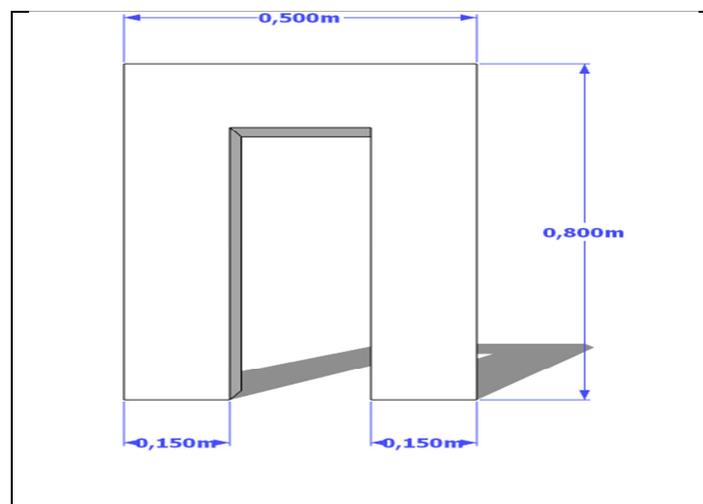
Vista frontal de un banco de concreto para la colocación de uno de los extremos de la columna semiterminada.
